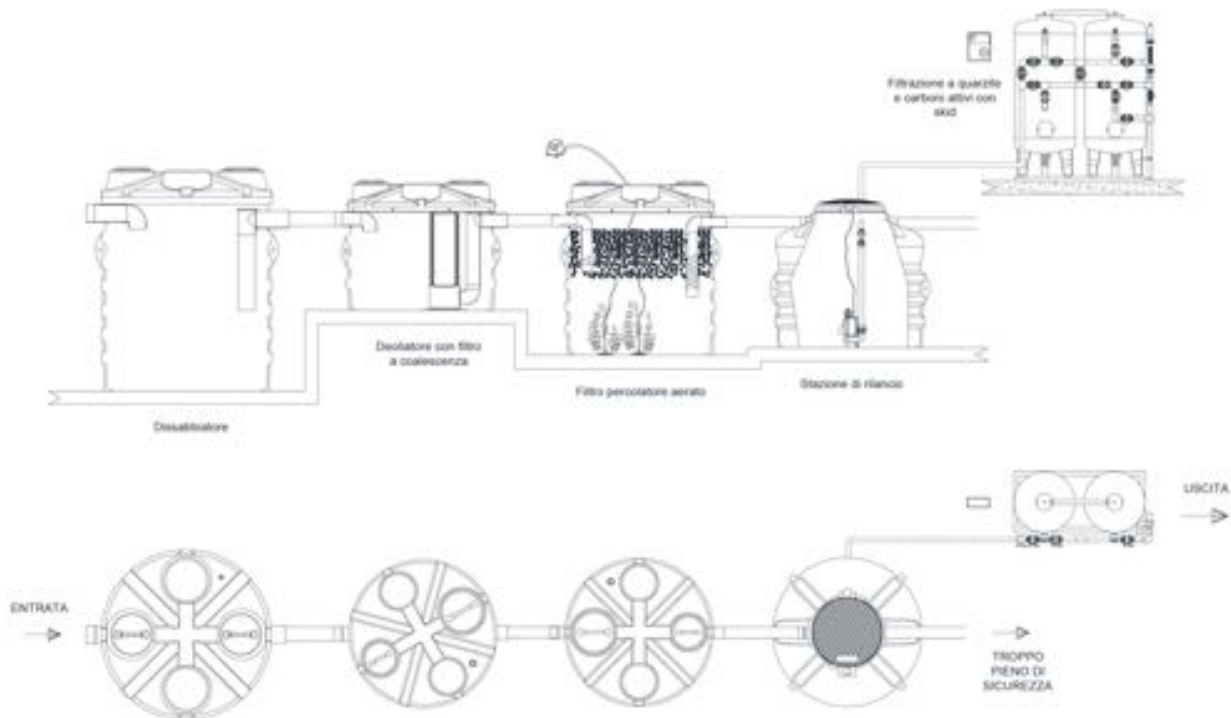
dettaglio costruttivo (sezione e planimetrica) del sistema di depurazione delle acque di lavaggio e sanificazione mezzi, pavimentazione e impianti nella zona sporca e reflui provenienti dal lavaggio della zona pulita (tavola 4quat) – Impianto Marca ROTOTEC - modello DEPAUTO100T4.
